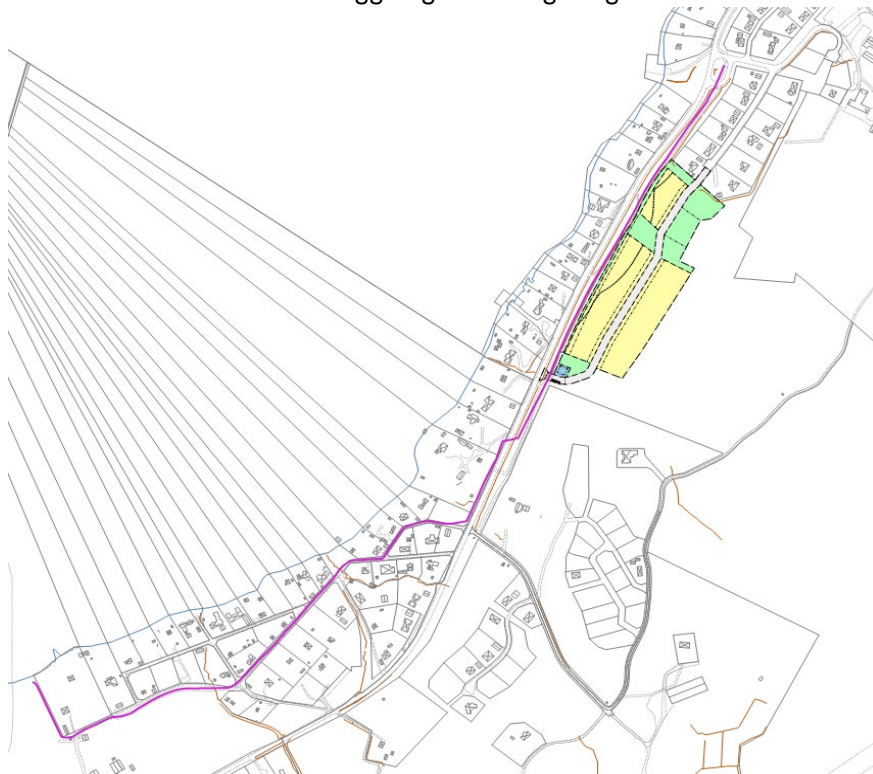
Gällande detaljplan för Järnklubban mfl (akt-1883-P13/9).
